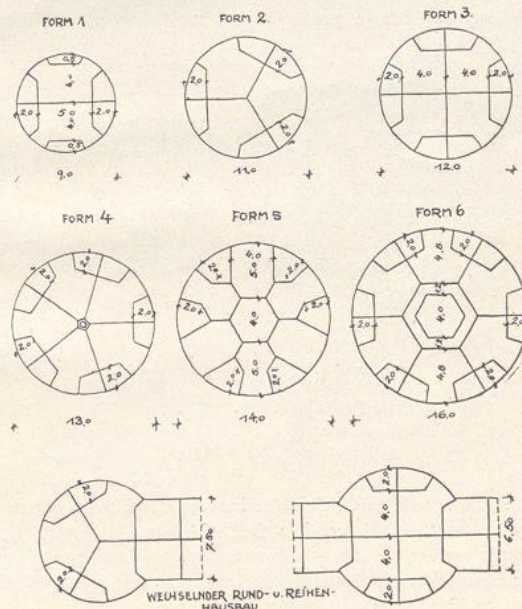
Schematische Darstellung von Grundrisslösungen beim Rundbau
